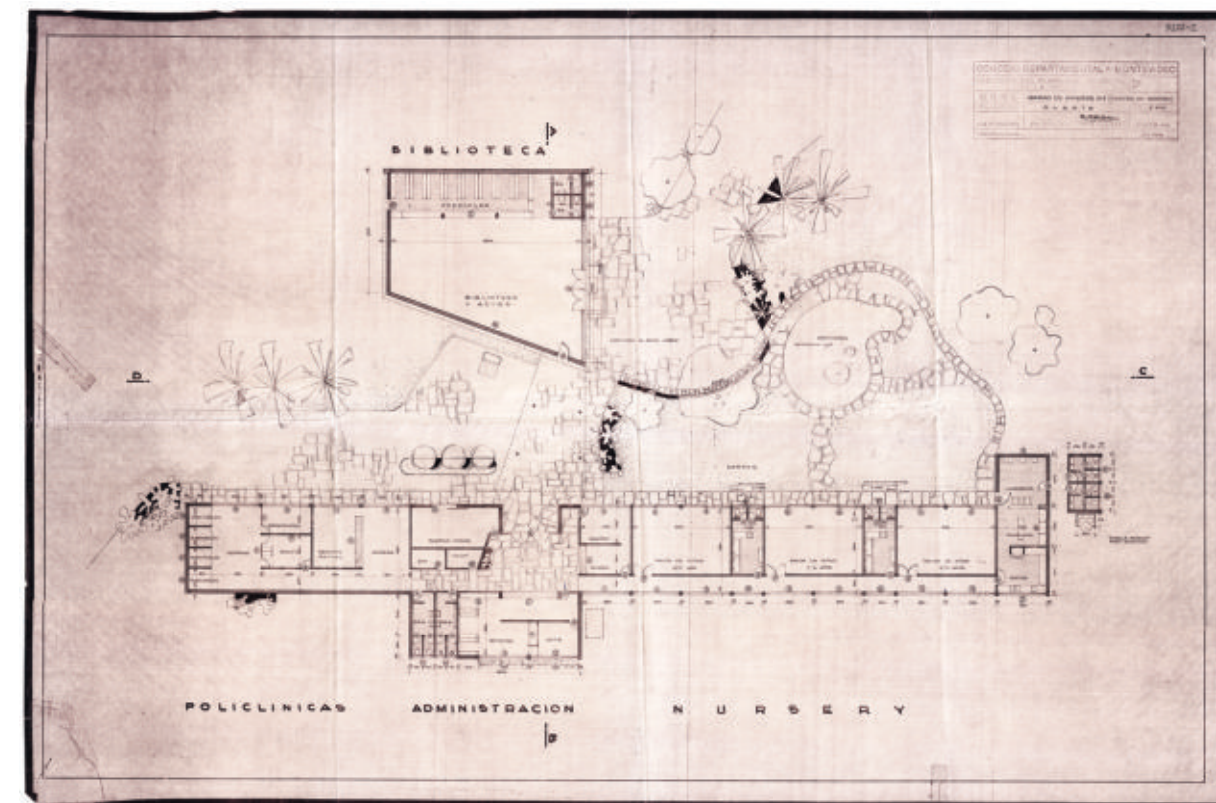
Planta del Centro de Barrio de la Unidad de Vivienda n°1 en Buceo. FUENTE: IHA, Fondo Bayardo, Carpeta 3222/2.
